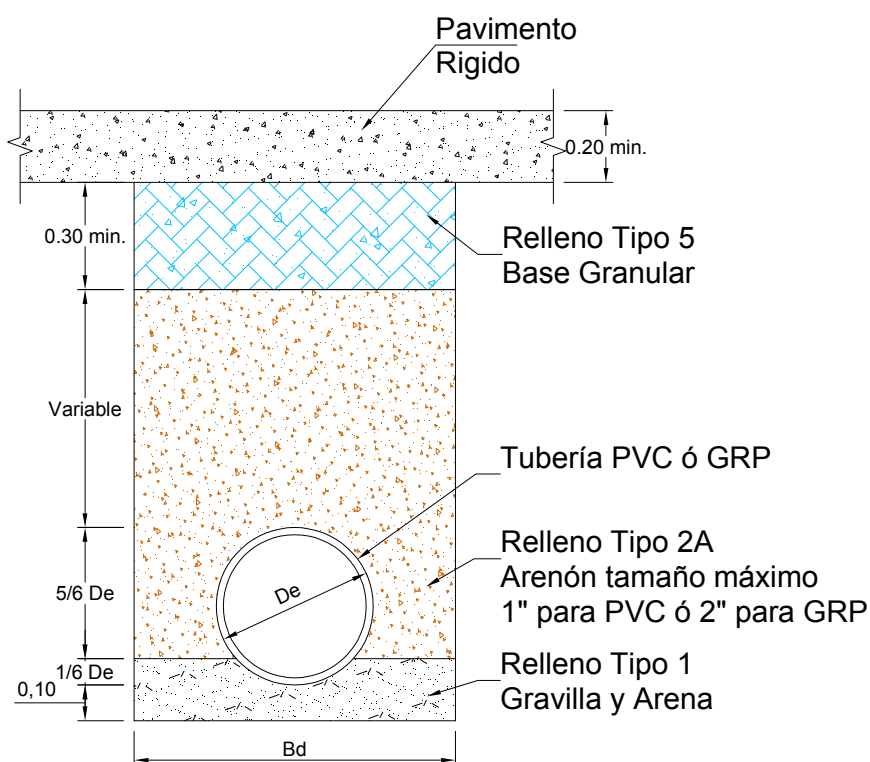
Cimentación Típica de tubería para vías de Pavimento Rígido
